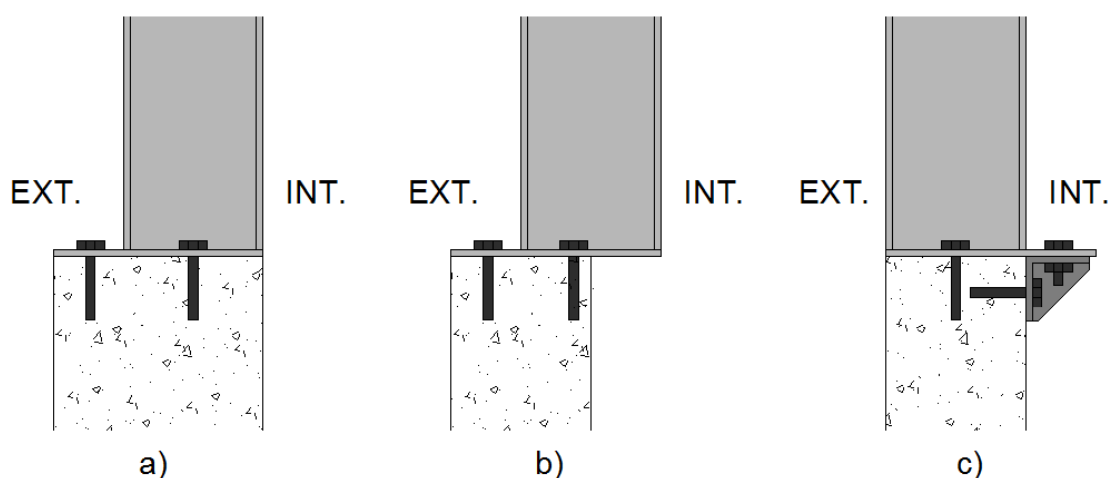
Alteração no posicionamento dos pilares metálicos
